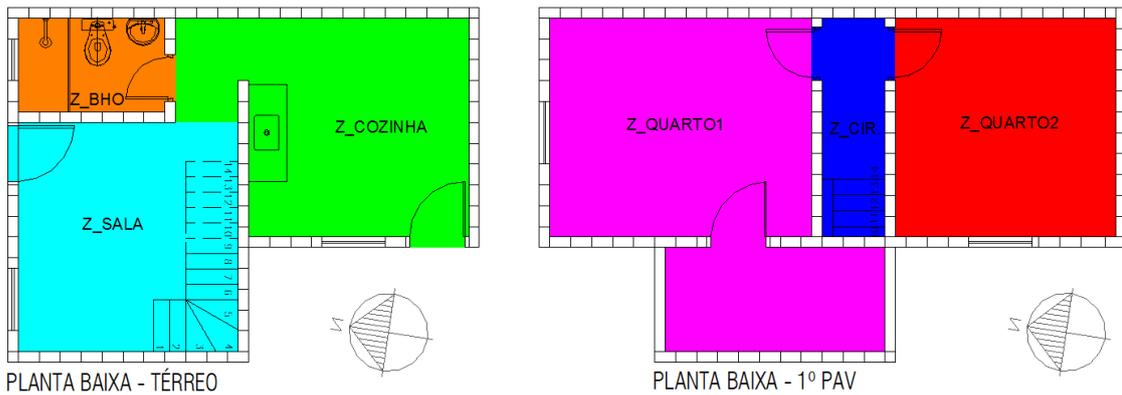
Plantas baixas dos dois pavimentos em zonas térmicas da tipologia sobrado urbano oeste
